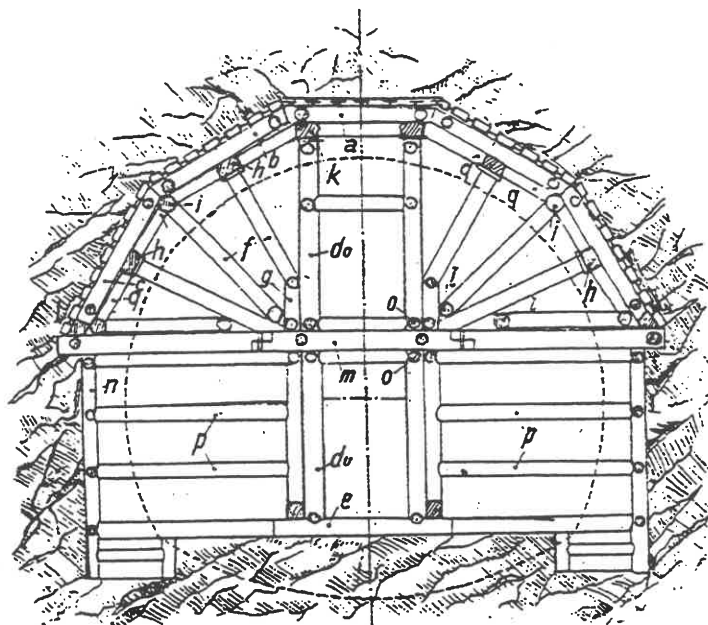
Baufolge bei der Sparrenzimmerung ("Alte Österreichische Tunnelbauweise")
